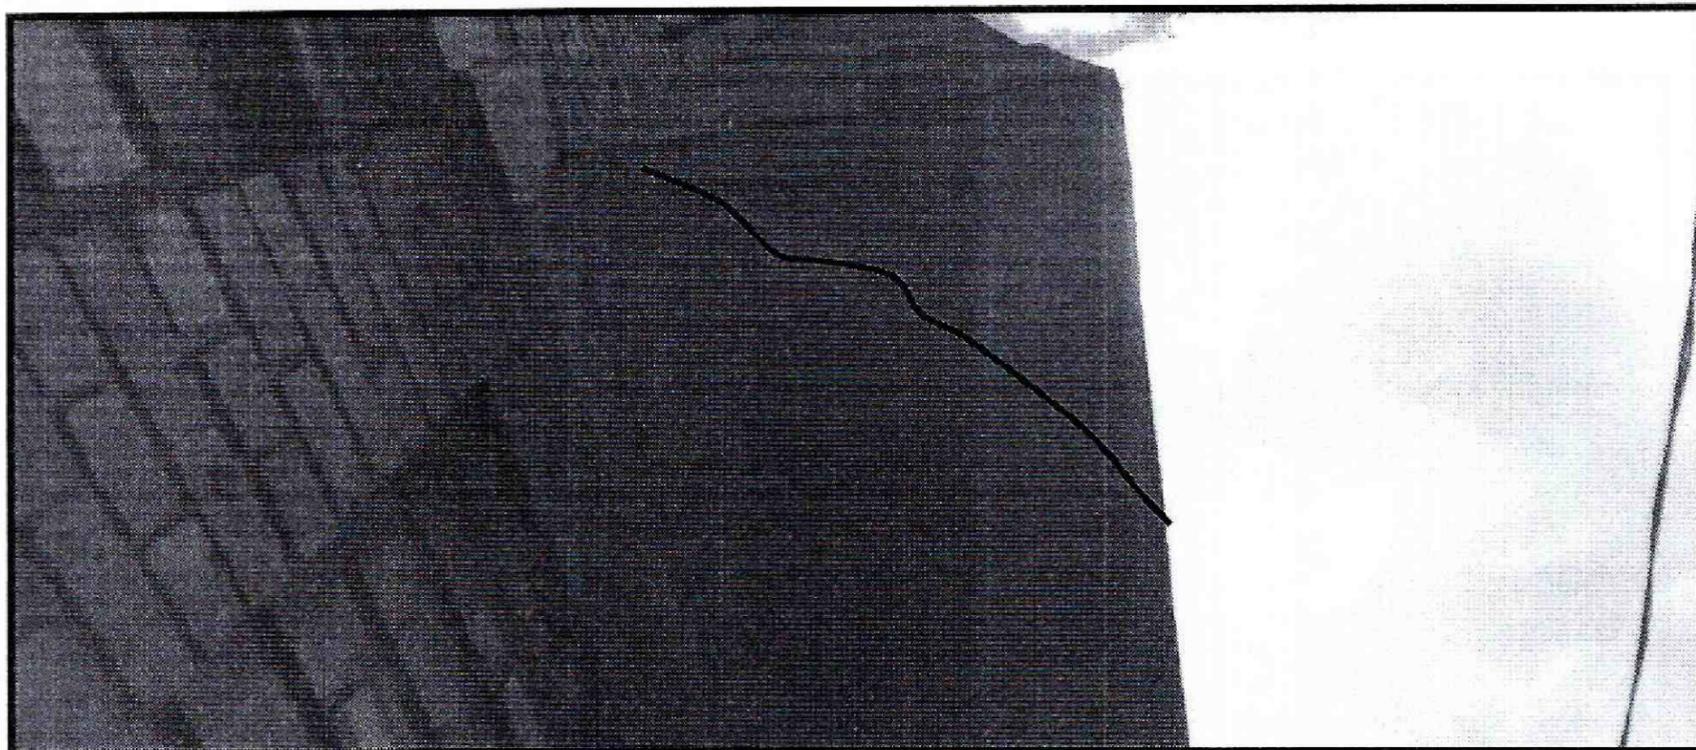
Fachada principal de la edificación ubicada en la Carrera 5B No 27 80 en el Sector Catastral San Diego de la Localidad de Santa Fé.
